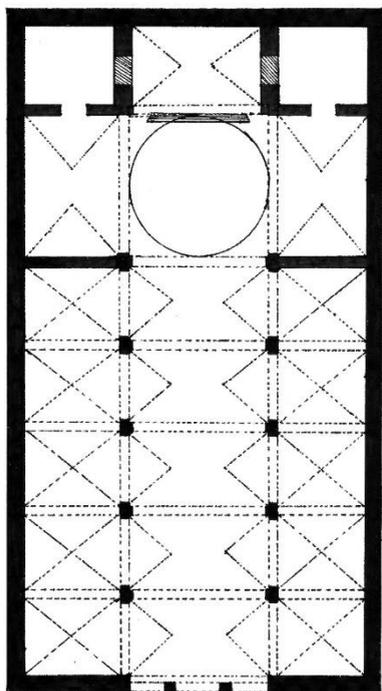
Planta. Iglesia del convento de Santa Teresa de Lazcano
